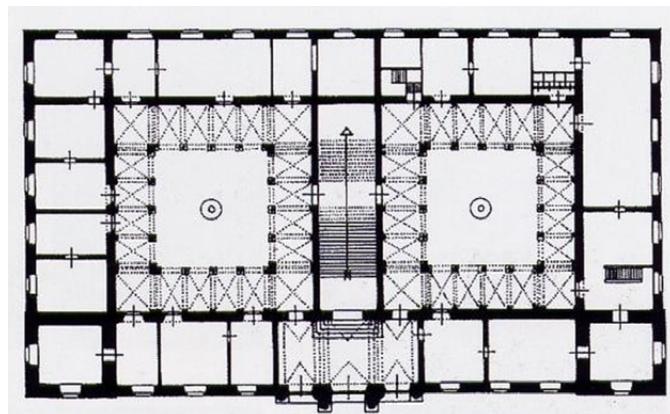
Planta de la Cárcel de la Corte (Madrid). Dos patios.
